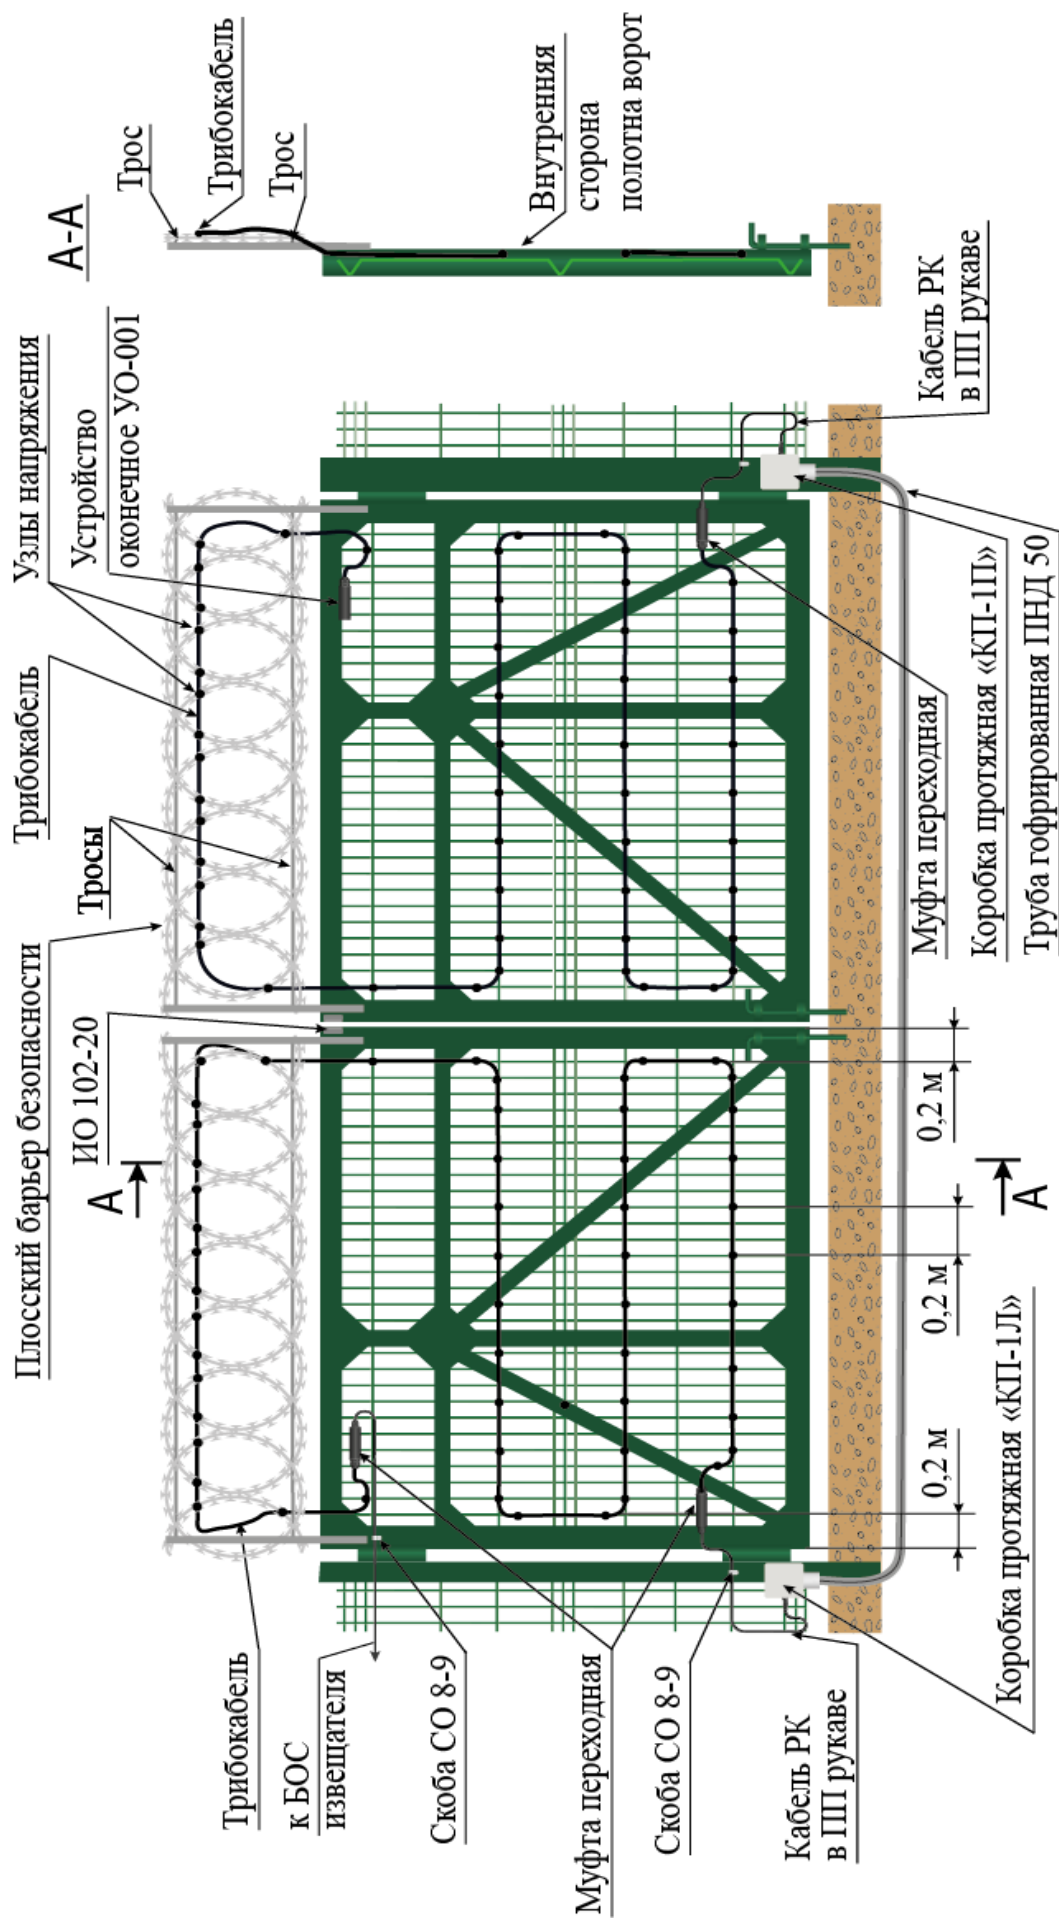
Вариант прокладки ЧЭ (трибокабеля) по полотну ворот из сварных решетчатых 3-D панелей и дополнительном ограждении из плоского барьера безопасности
